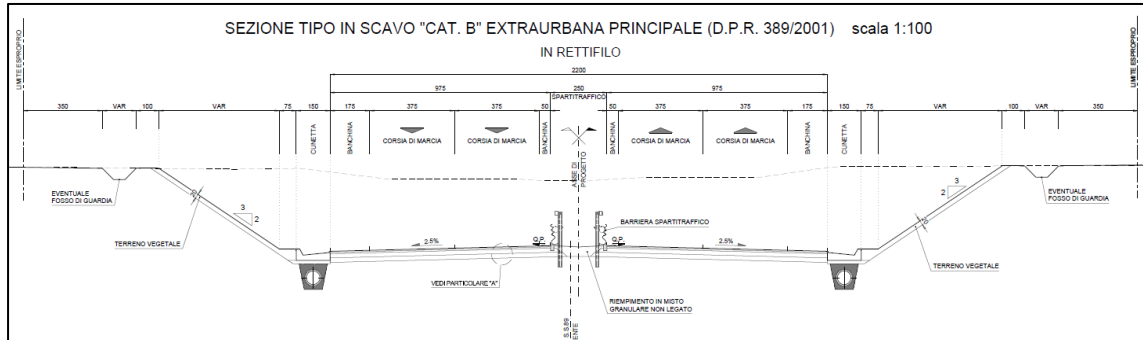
Sezione tipo asse principale, trincea, rettifilo. (stralcio elaborato T00PS00TRAST01A allegato al Progetto Definitivo)
